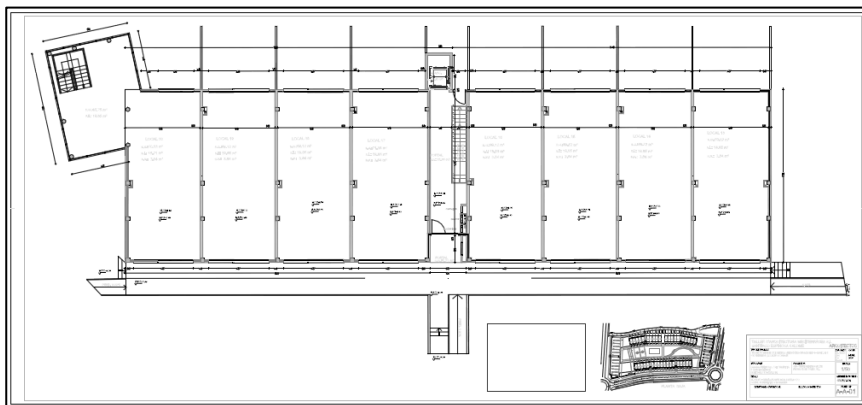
Juntas 1 y 2 - P. Baja. Fuente propia
